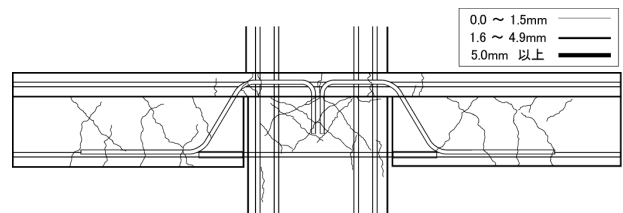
R=1/30 加力後のひび割れ図 (SB-1)
